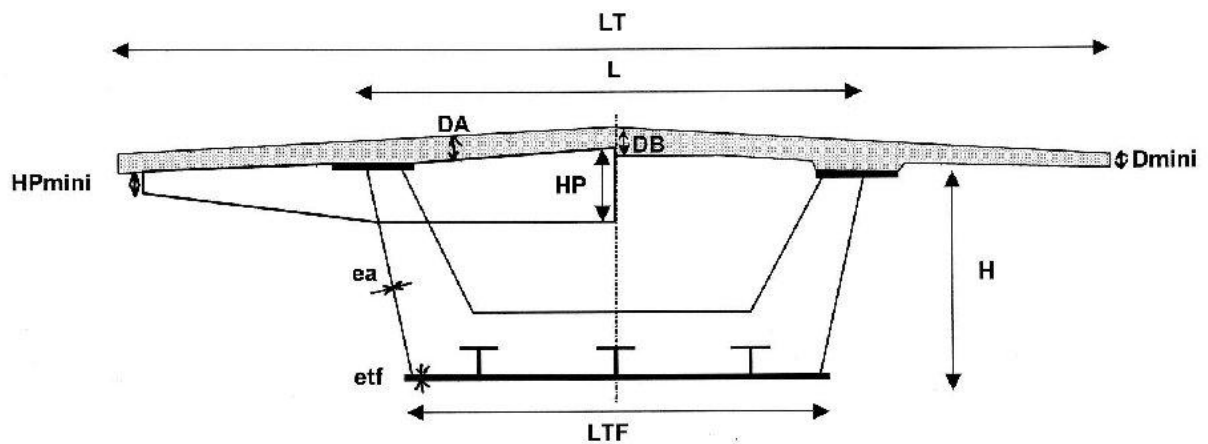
Dimensionnement du pont caisson ouvert mixte
